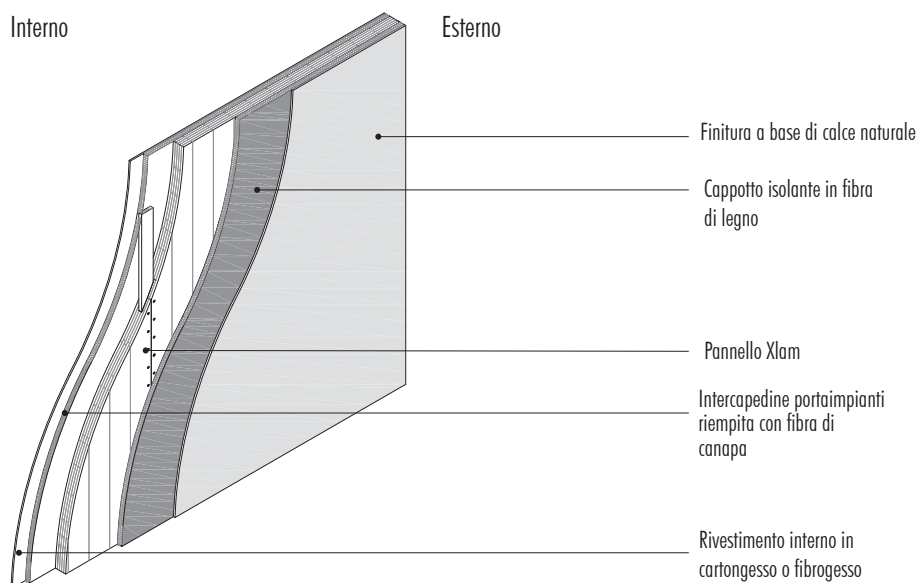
Esempio di pacchetto parete Xlam completa.
